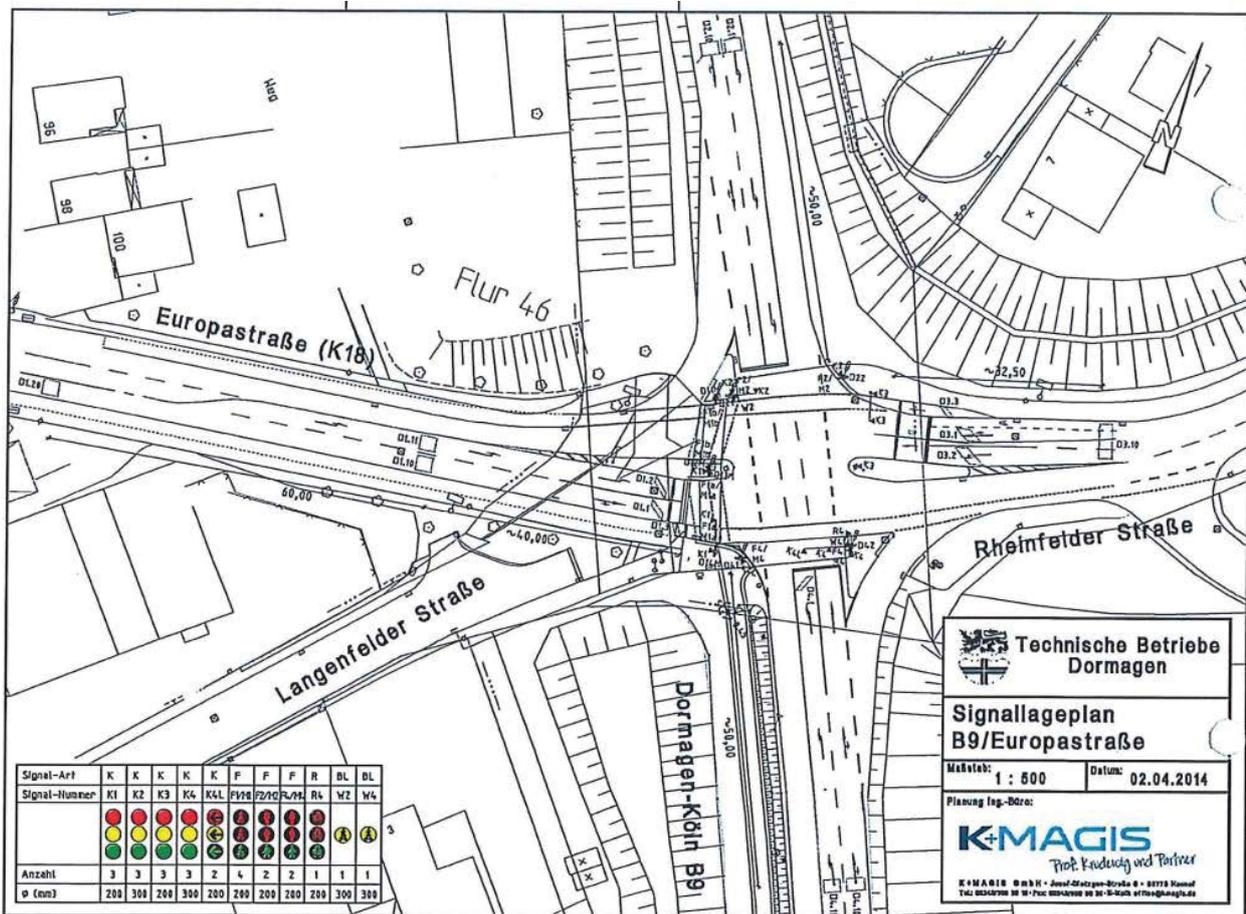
Signallageplan B9 / Europastraße (KP 3) (vgl. K+Magis, 2014)
